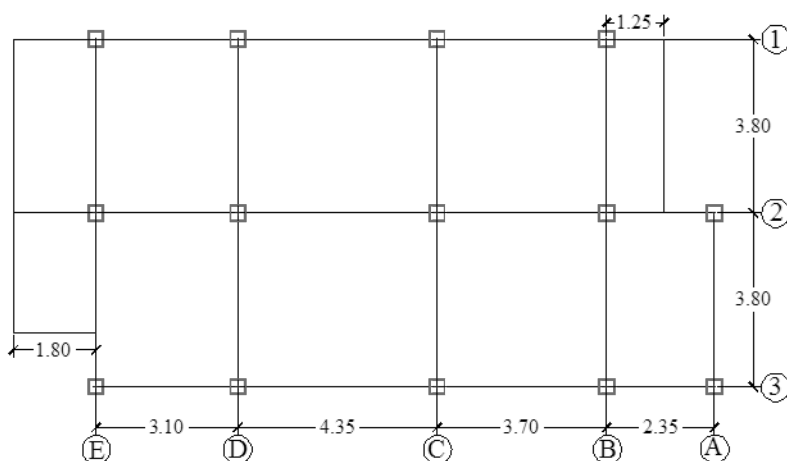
Vista de planta de las columnas y ejes estructurales del edificio estudiado
